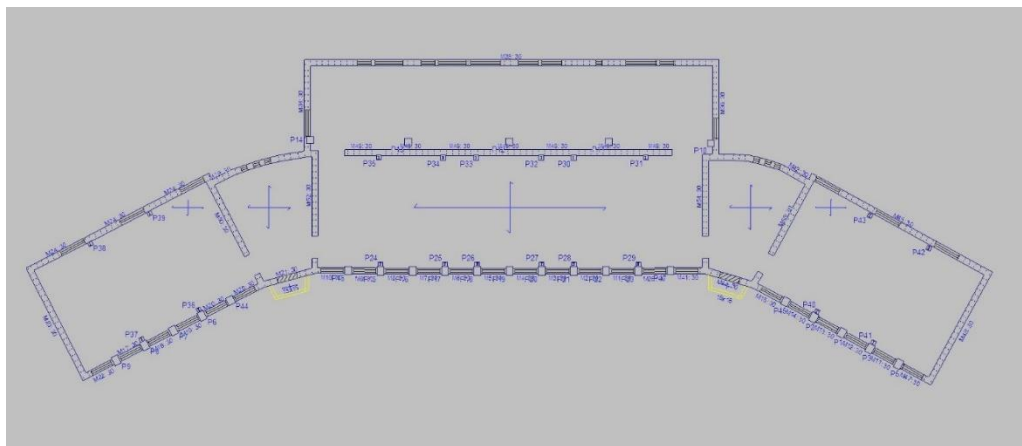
Planta 1 del modelo de 5 plantas simplificado
